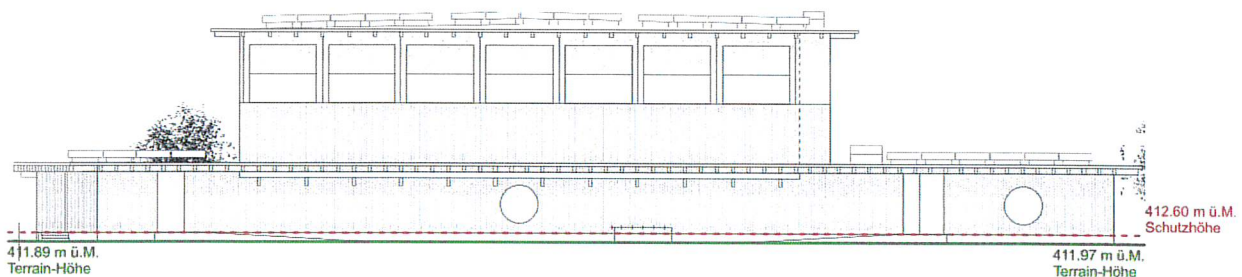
Fassadenansicht Nordwest-Südwest mit eingezeichneter Schutzhöhe und Terrainhöhe. Plan aus Vorprojekt Stand 23.10.2025
